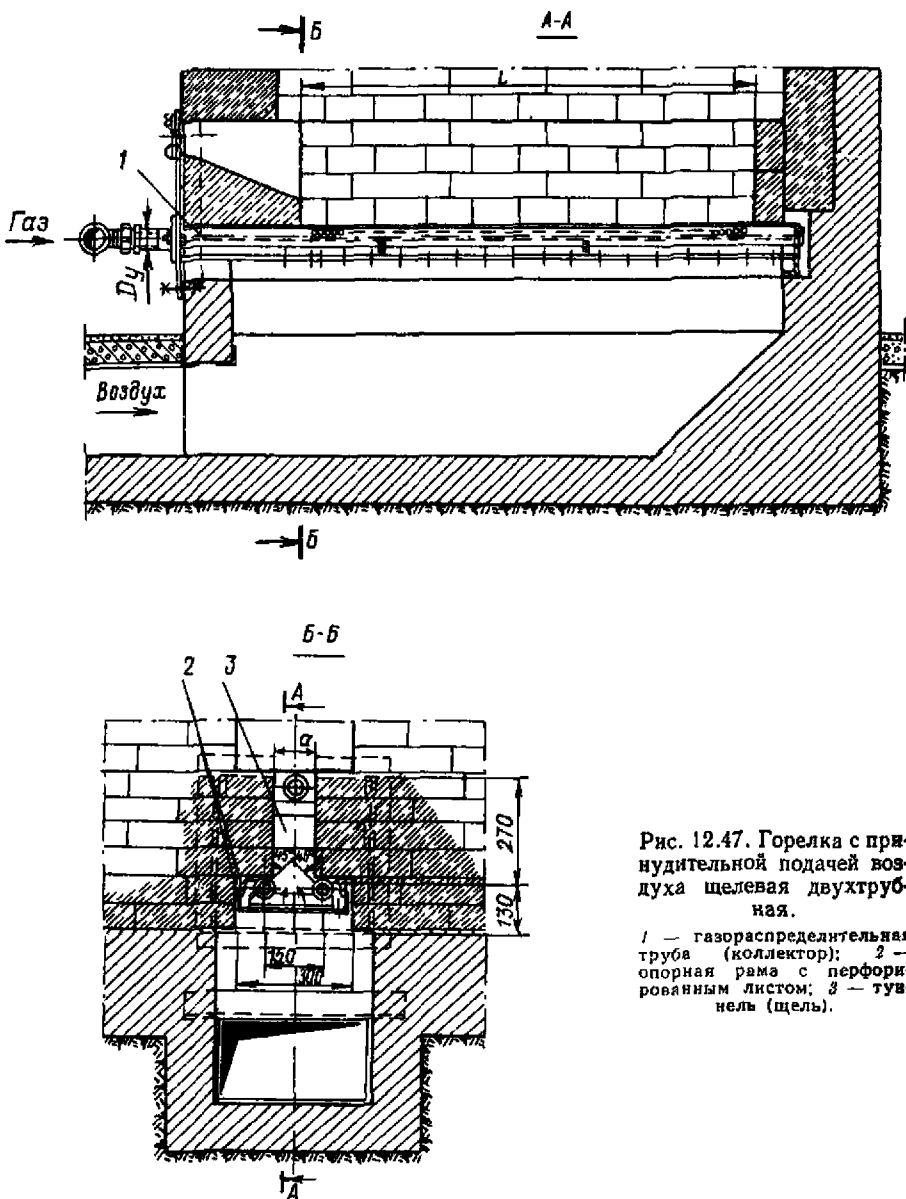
Горелка с принудительной подачей воздуха щелевая двухтрубная.
